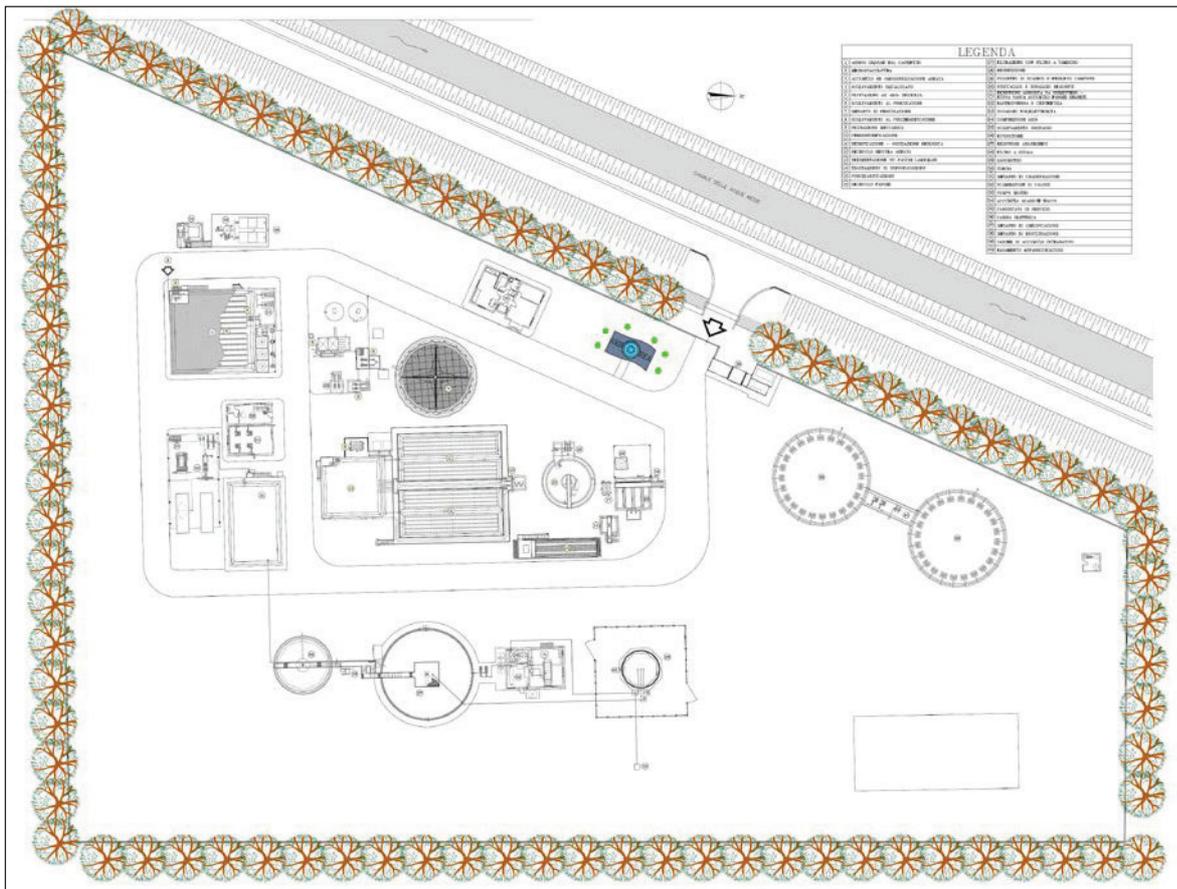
Planimetria dell'impianto di depurazione prima dell'intervento
